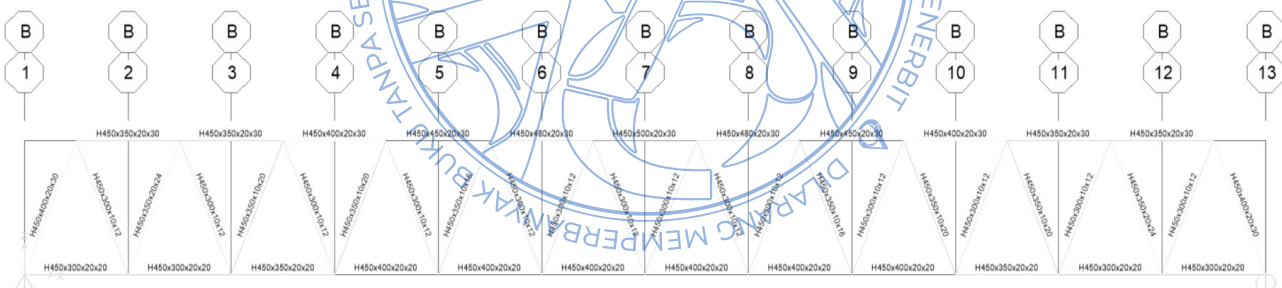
Balok yang Sudah Termodelkan Pada elevasi Bottom
